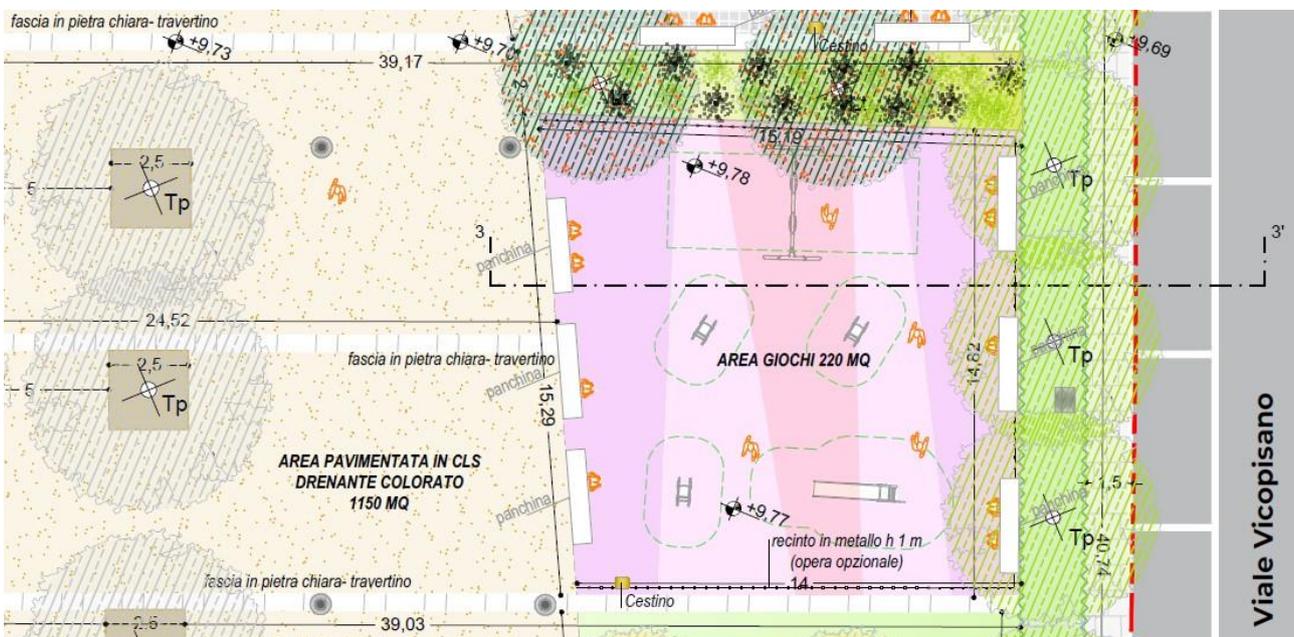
Estratto dell'elaborato T.04 – Planimetria – Stato di progetto – con dettaglio della planimetria del campo gioco
